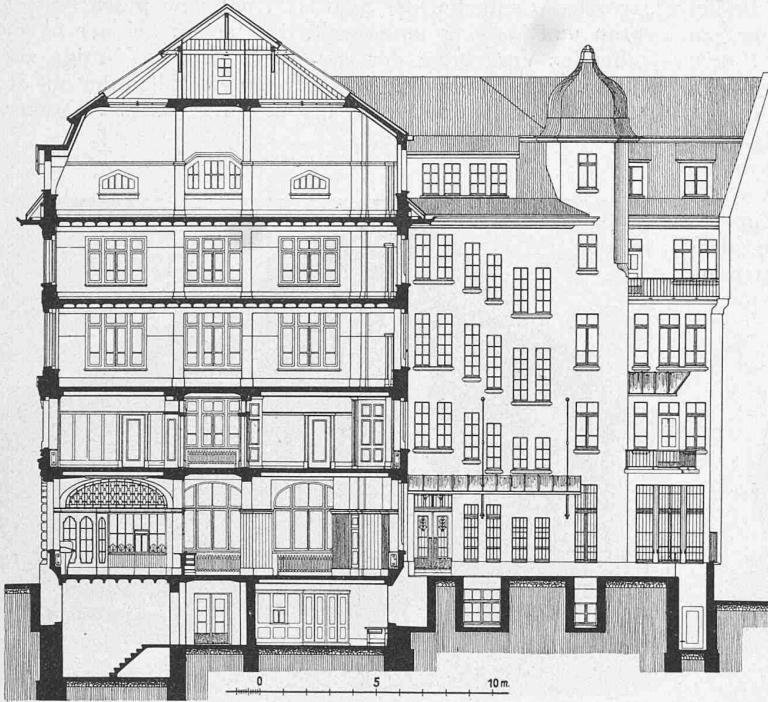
Schnitt senkrecht zur Brandschenkestrasse, und Hoffassade. — 1 : 250.
